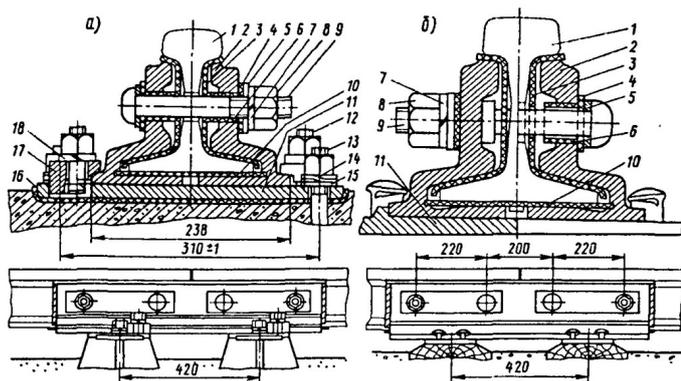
Изолирующий стык с металлическими объемлющими накладками: а–при железобетонных шпалах и креплении ; б–при деревянных шпалах с костыльным креплением; 1 – рельс, 2 – накладка, 3 – прокладка боковая , 4 – полиэтиленовая планка под болт, 5 – металлическая стопорная планка, 6 – втулка, 7 –пружинная шайба, 8 – гайка, 9 – стыковой болт, 10 – изолирующая прокладка под рельс, 11 – подкладка, 12 – клеммный болт, 13 – закладной болт, 14 – пружинная шайба, 15 – плоская шайба, 16 – прокладка под прокладку, 17 – клемма, 18 –шайба.
